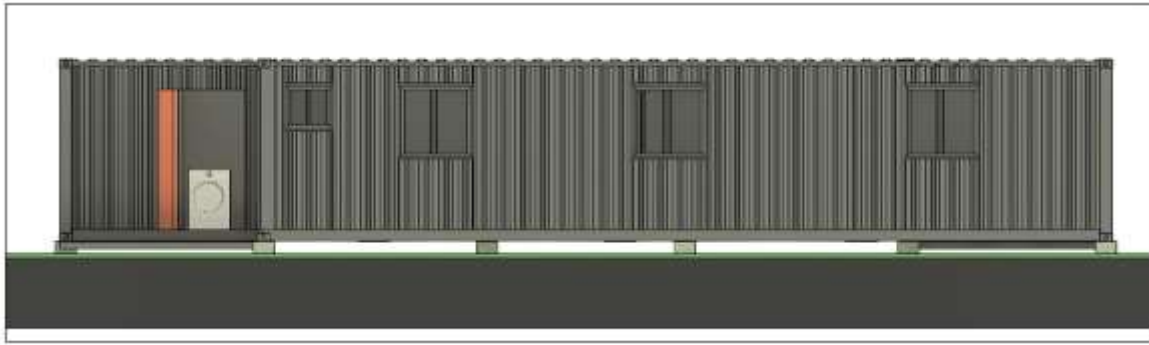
fachada frontal, 2025-II, Wilson Lozano.
